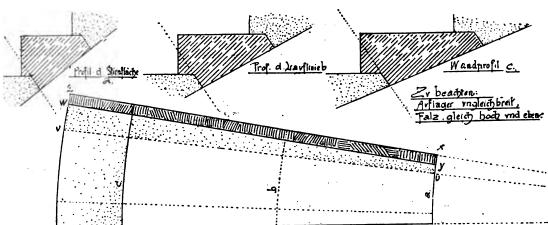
bis 468. Treppenstufen mit ebenen Falzen.
